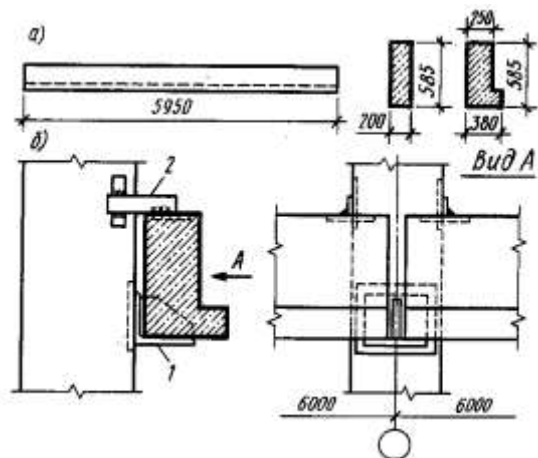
Обв'язувальні балки: а – загальний вигляд; б – вузол кріплення до колони; 1 – сталевий опорний столик; 2 – сталева планка.
